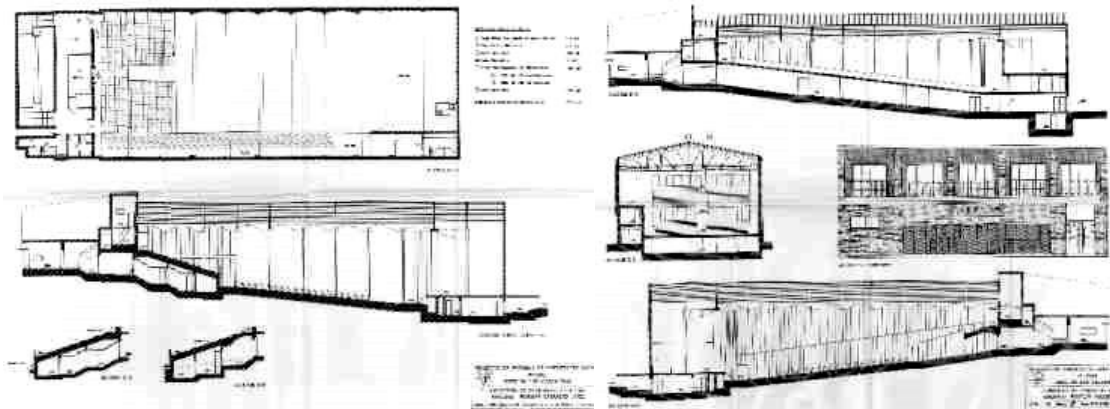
Plano de planta alta y sección longitudinal sin reformar. Figura 1010. Plano de Sección y Alzados reformados (CARRASCO LÓPEZ, R., 1994).
